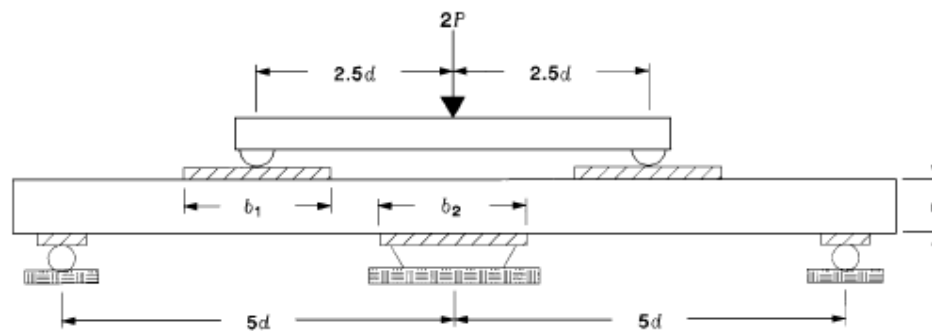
Configuração do teste de cisalhamento em viga em 5 pontos
